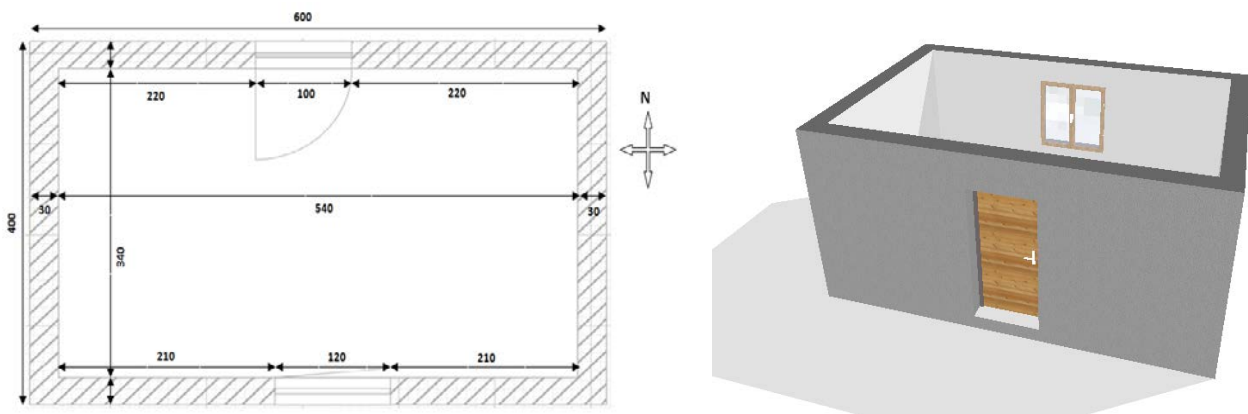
Vue en plan de la construction. Figure IV.2. Vue 3D de la construction modélisée.
